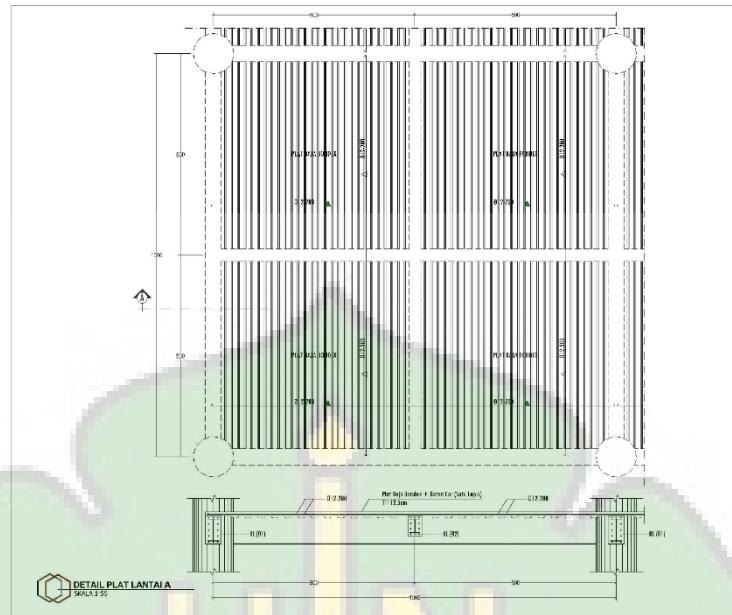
96 Denah Plat Lantai Lantai 5 (Rooftop)
